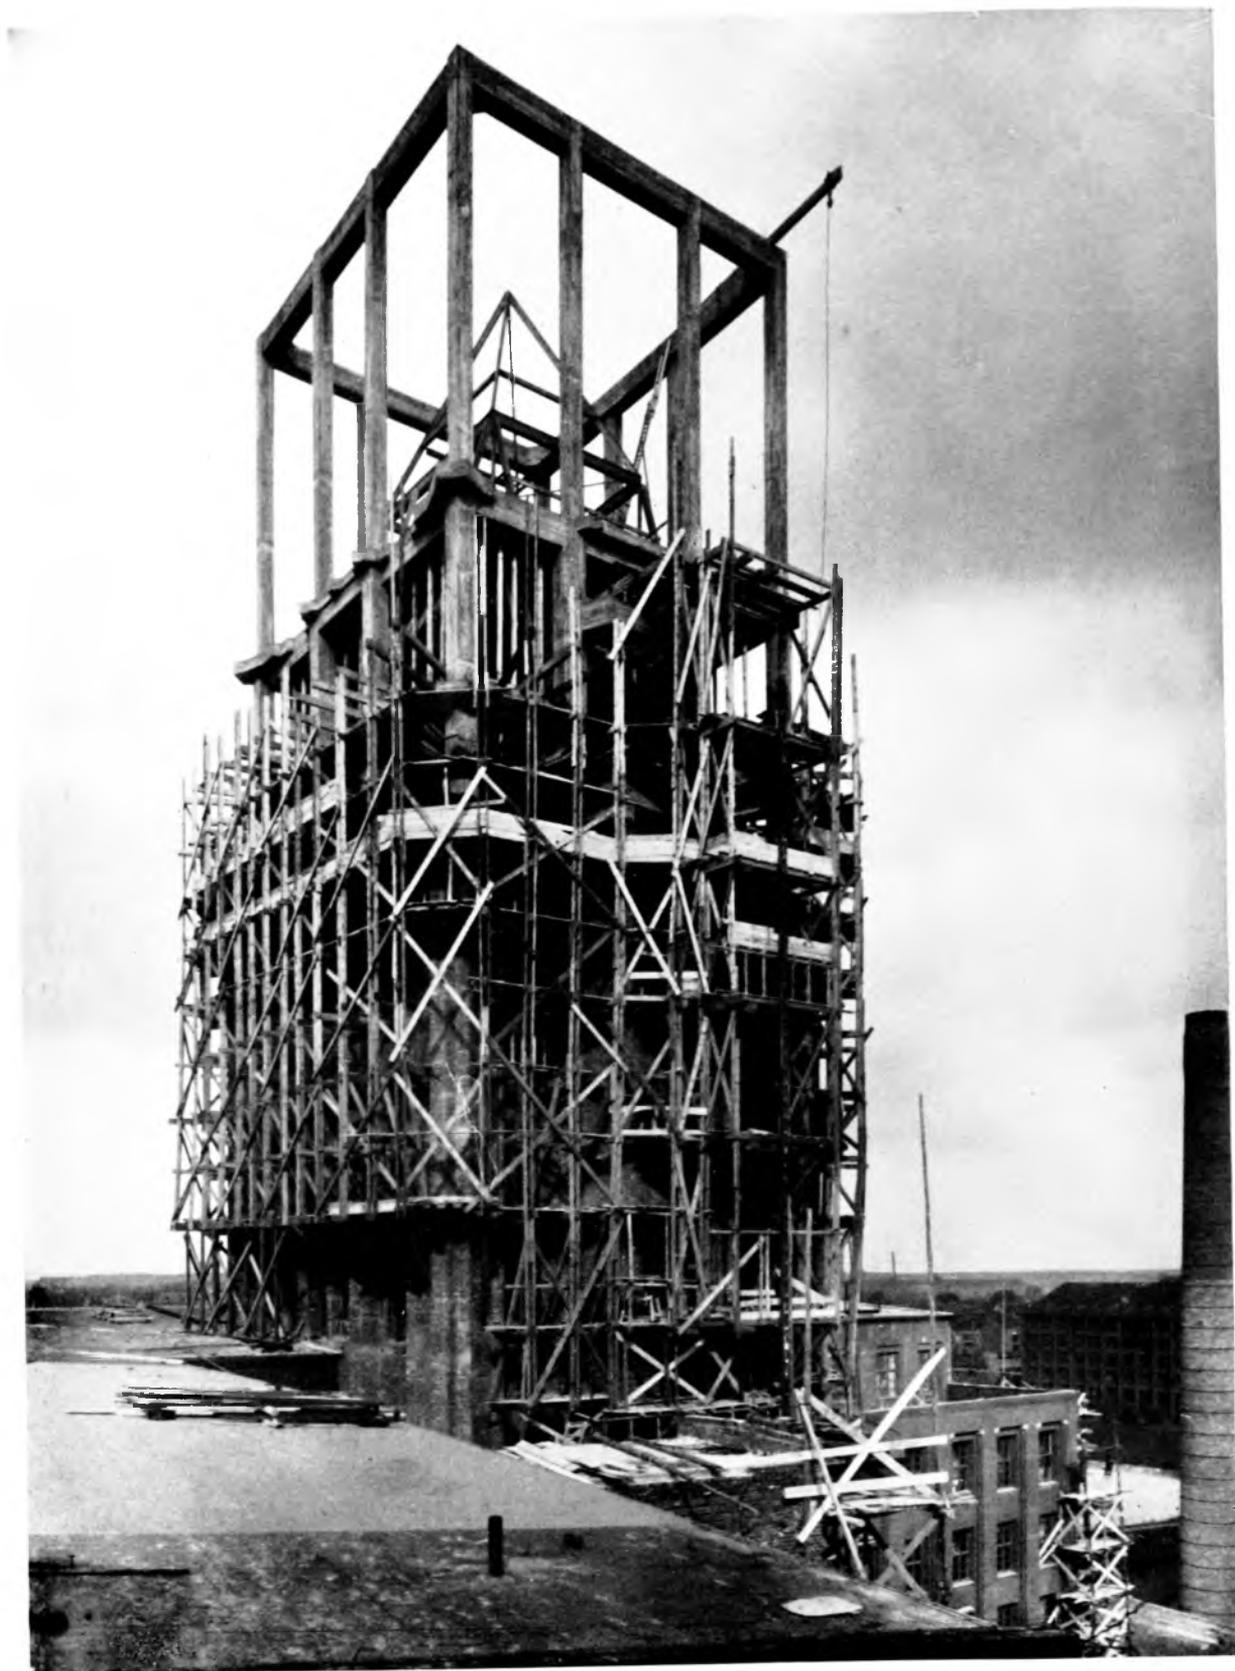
Eisenbetonkonstruktion des XIII. Turmgesschosses; das eiserne Zeltdach ist aufgestellt
